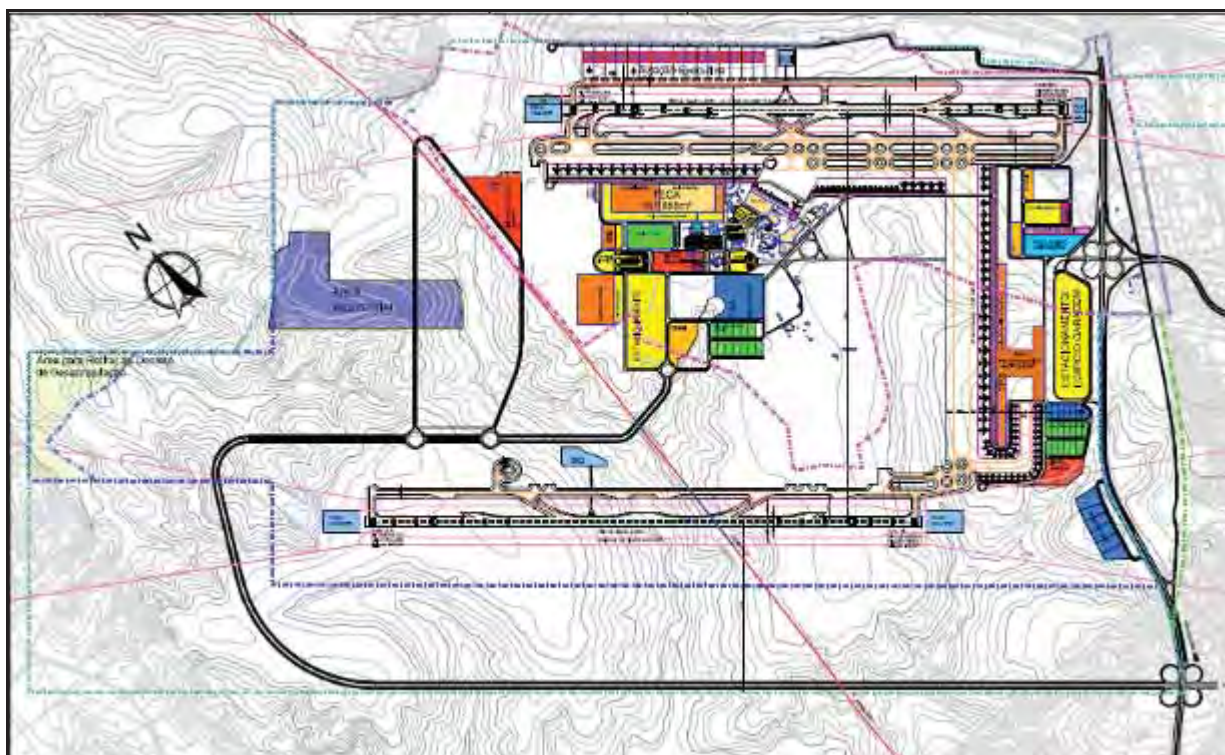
Situação futura em 2015 (PLANWAY, 2007)
